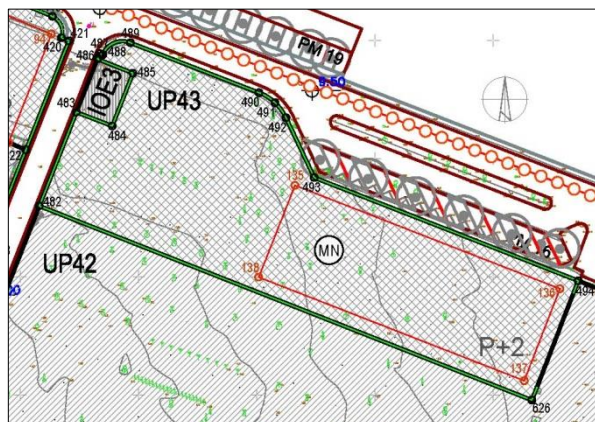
Plan mjera za sprovođenje i plan namjene površina
